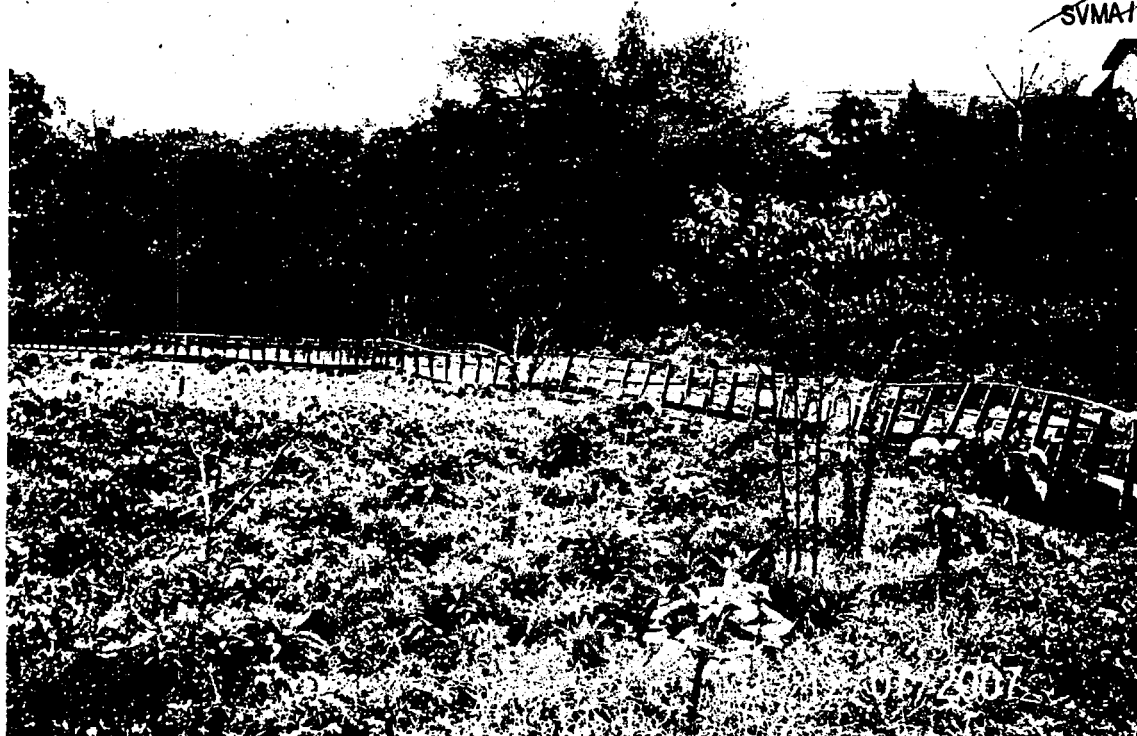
Vista em plano geral da passarela de madeira colapsada. Foto obtida em 12/07/2007.
